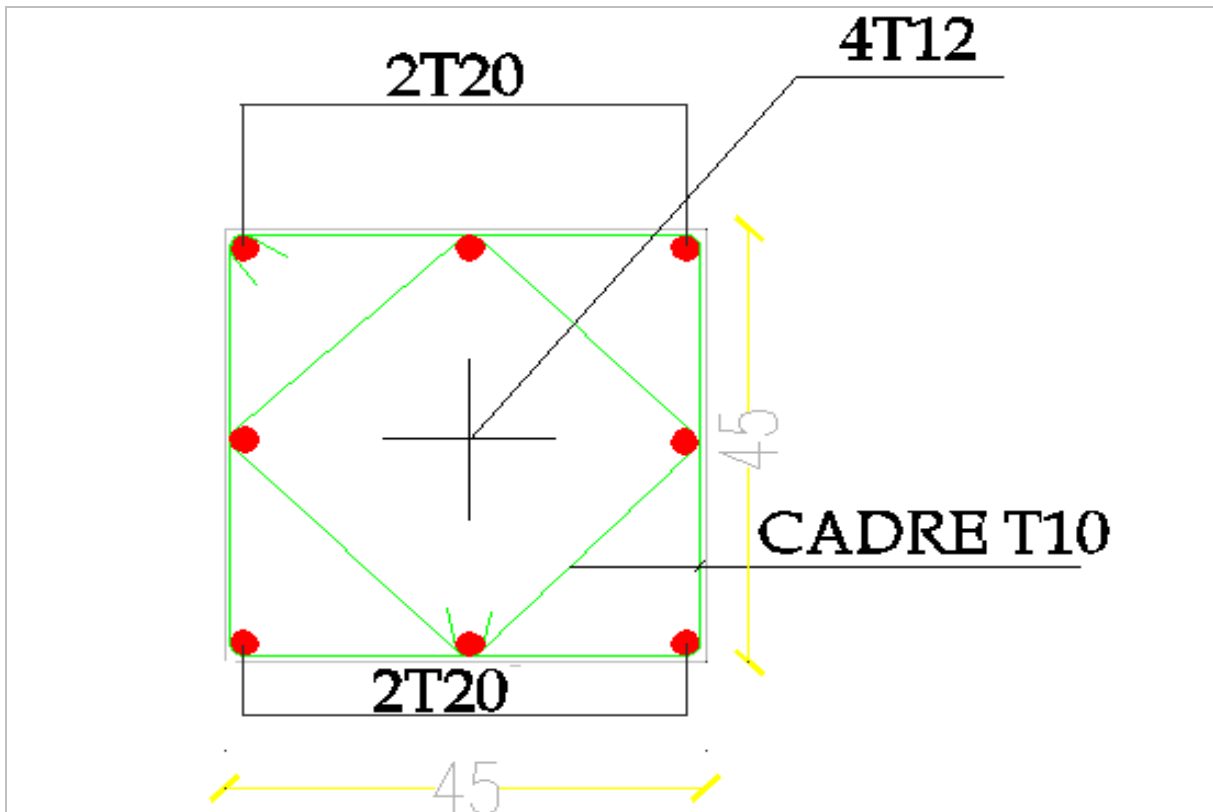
Ferrailage des poteaux carrés 45 x 45.
